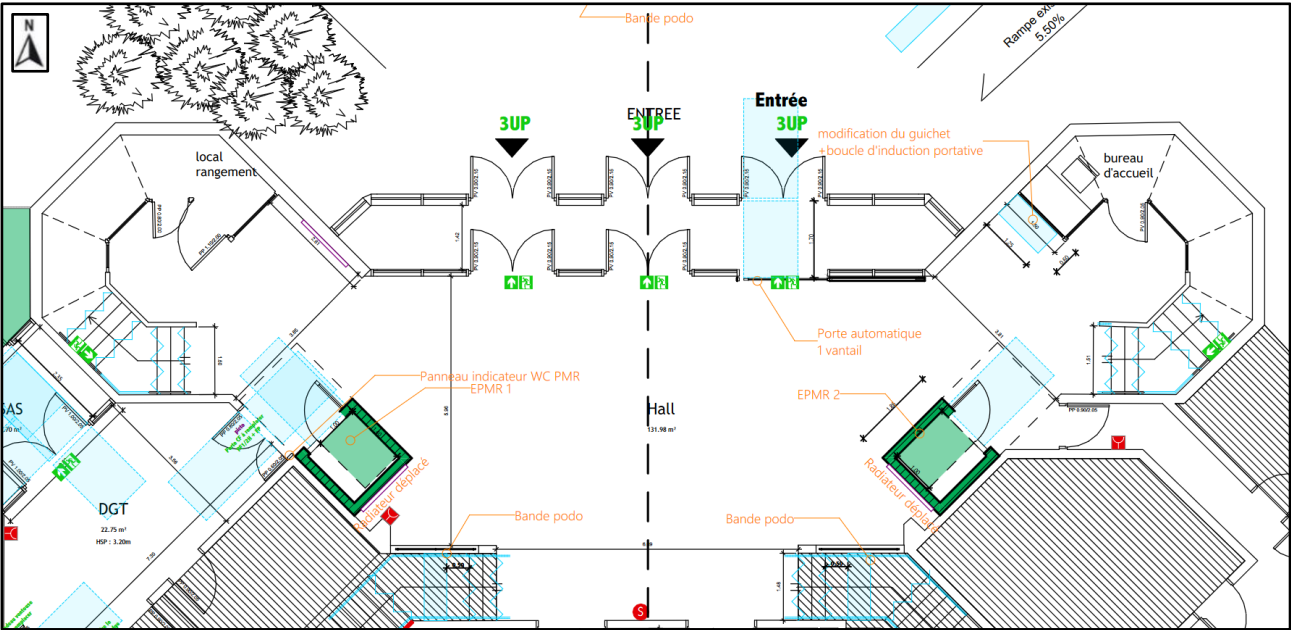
Plan masse zoomé au RDC de l'existant et du projet de mise en place des 2 élévateurs (notés EPMR 1 et EPMR 2) en date du 25/09/2024 (source : ATELIER D'ARCHITECTURE TANDEM)
